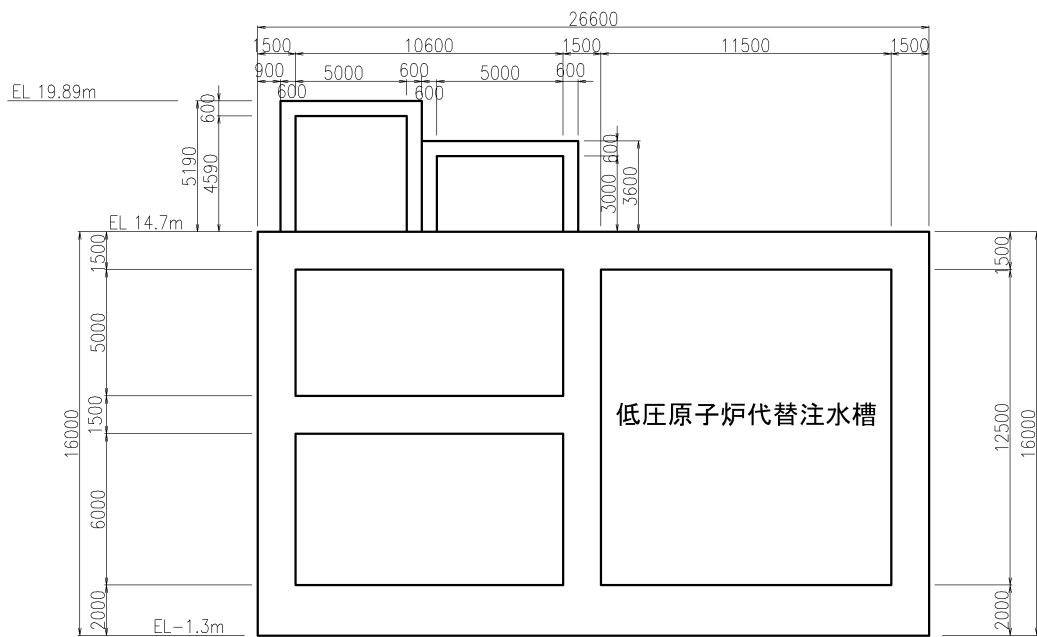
低圧原子炉代替注水ポンプ格納槽 断面図 (C-C 断面) (単位:mm)
